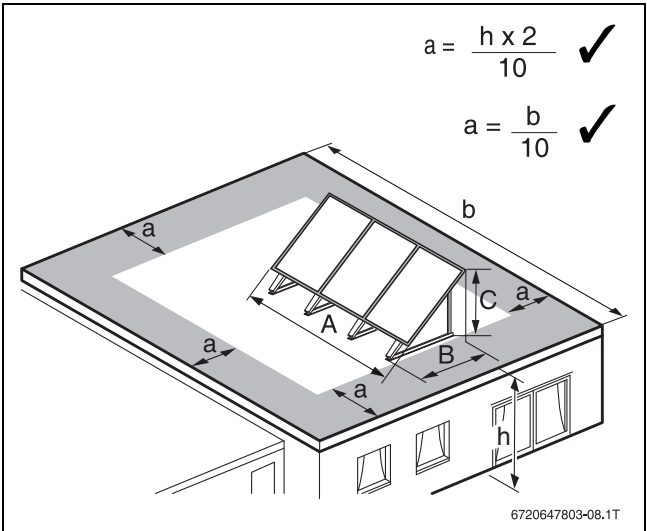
Einzuhaltende Abstandsmaße, Flachdach
